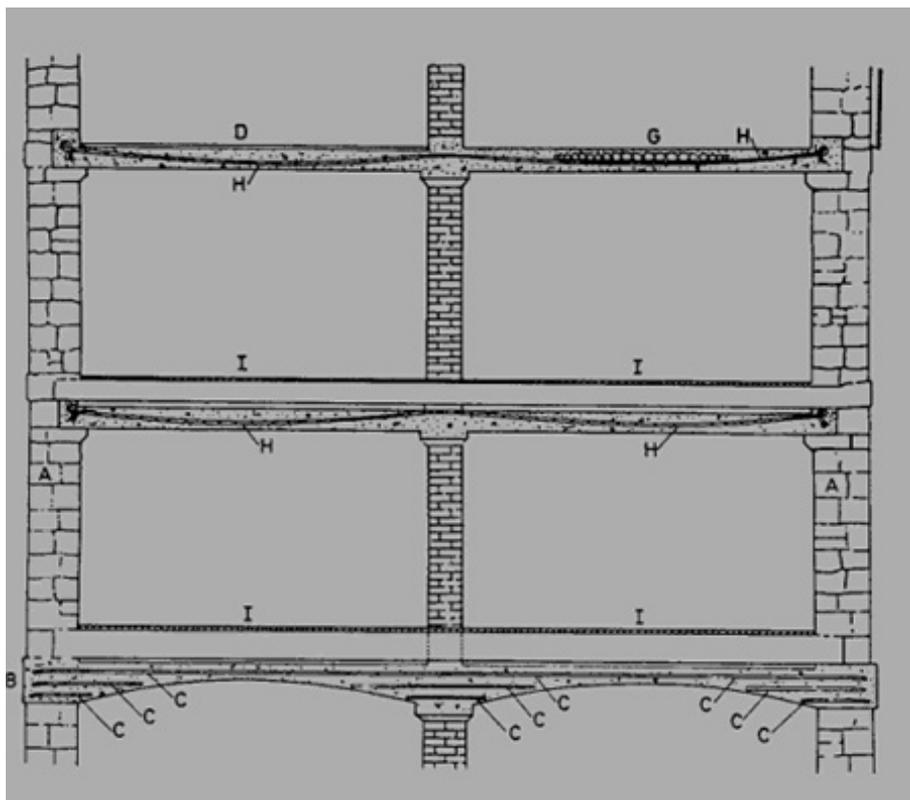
Corte construtivo de uma casa de criados com dois andares. Utilização de lajes de cimento reforçado com barras de ferro e malha-sol resultando num dos primeiros edifícios de betão armado. Projectado por W. Wilkinson of Newcastle, 1854. Wilkinson patenteou o cimento reforçado como técnica de protecção dos edifícios contra incêndios
